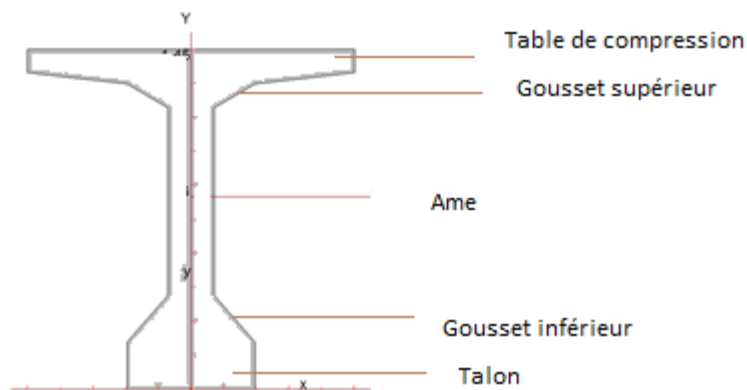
Terminologie et coupe transversale d'une poutre
